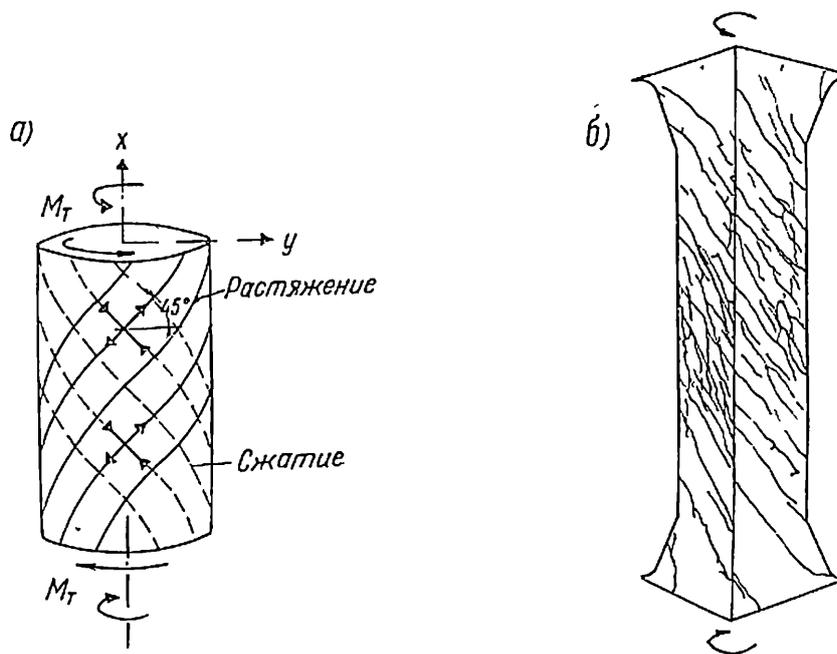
1. Направление траекторий главных напряжений при кручении (а) и образование трещин в железобетонной призма (б)
